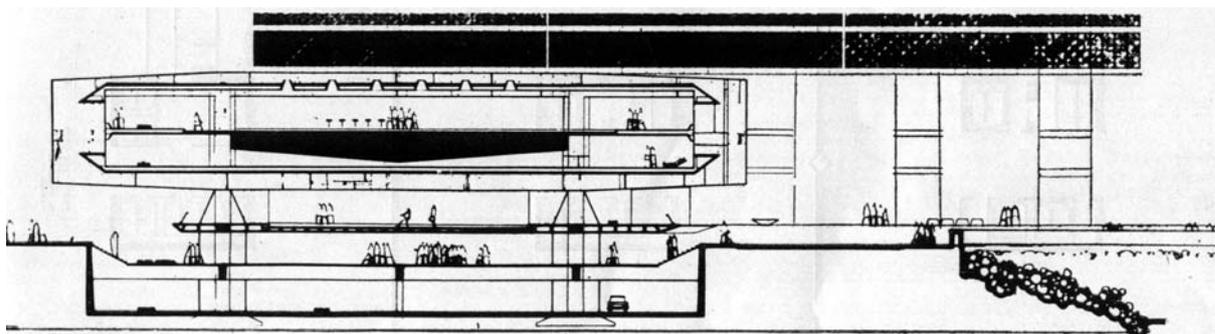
corte transversal C: subsolo: garagens; nível semi-enterrado: áreas comerciais; praça elevada; 1º nível do pavilhão: saunas, fisioterapia e vestiários; 2º nível do pavilhão: piscina.
